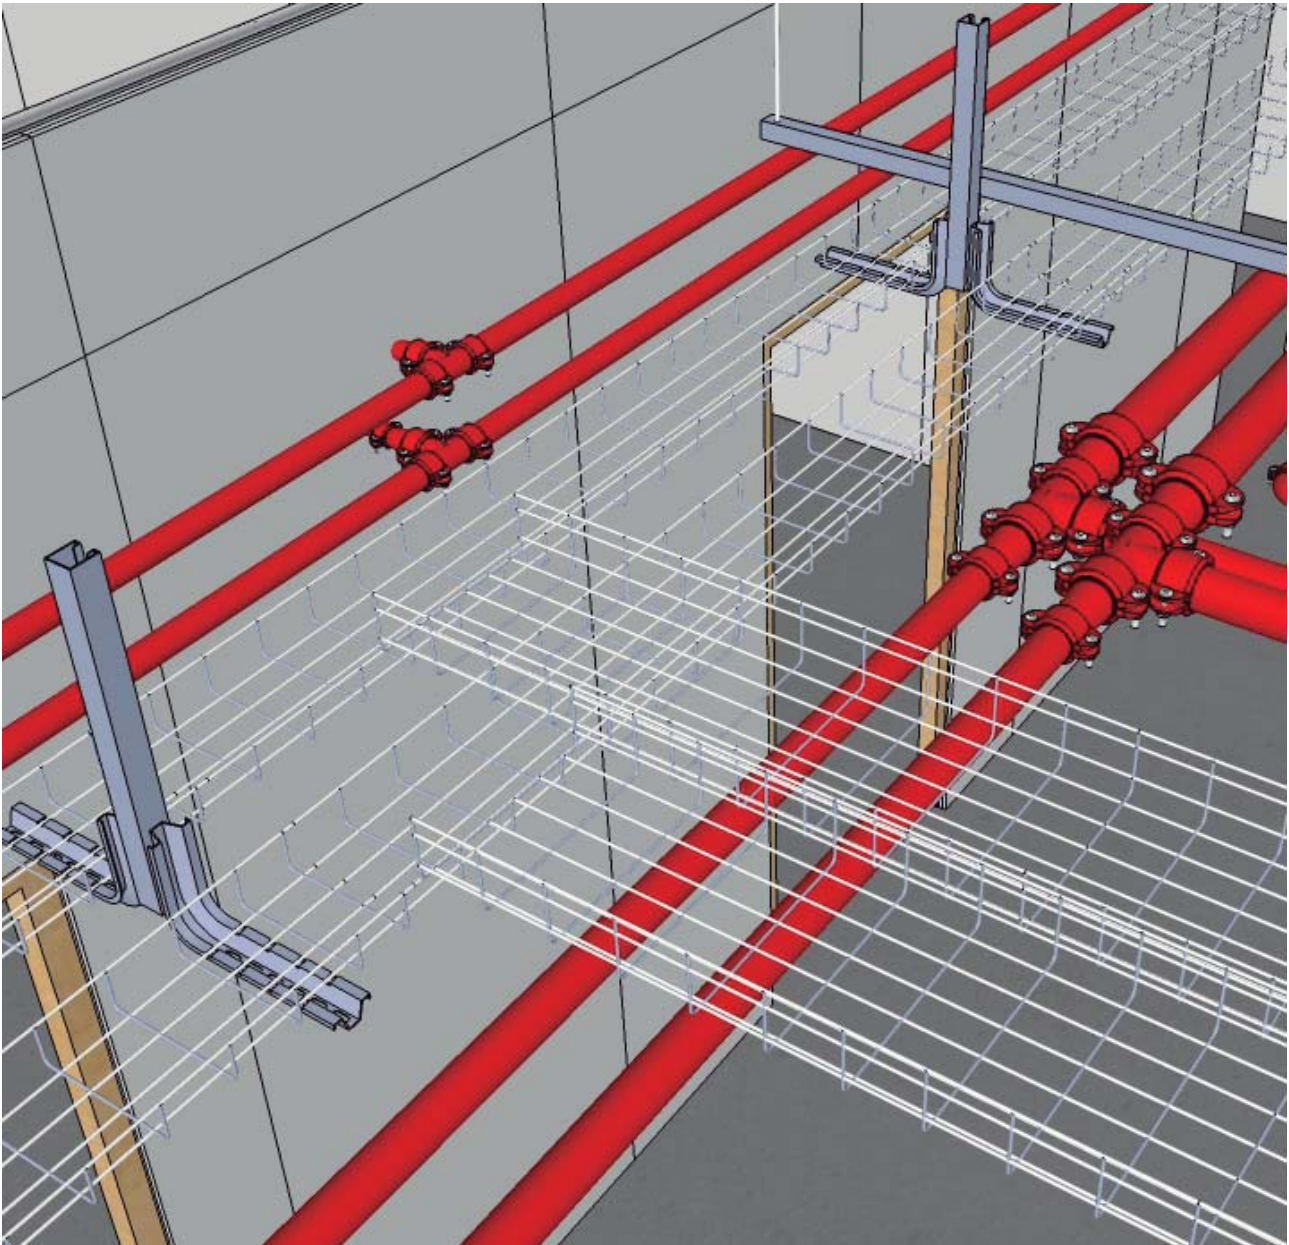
26- Bandejas de instalaciones en la planta segunda. Se observan también las puertas de los despachos de profesores y el pladur de las paredes.
